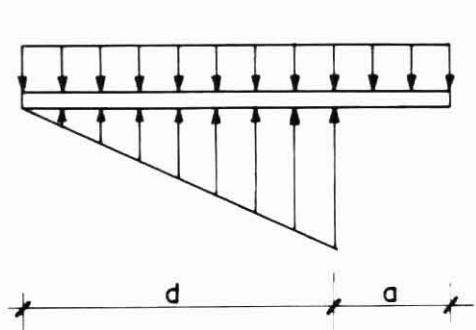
Placa de aplastamiento con un lado en voladizo.
